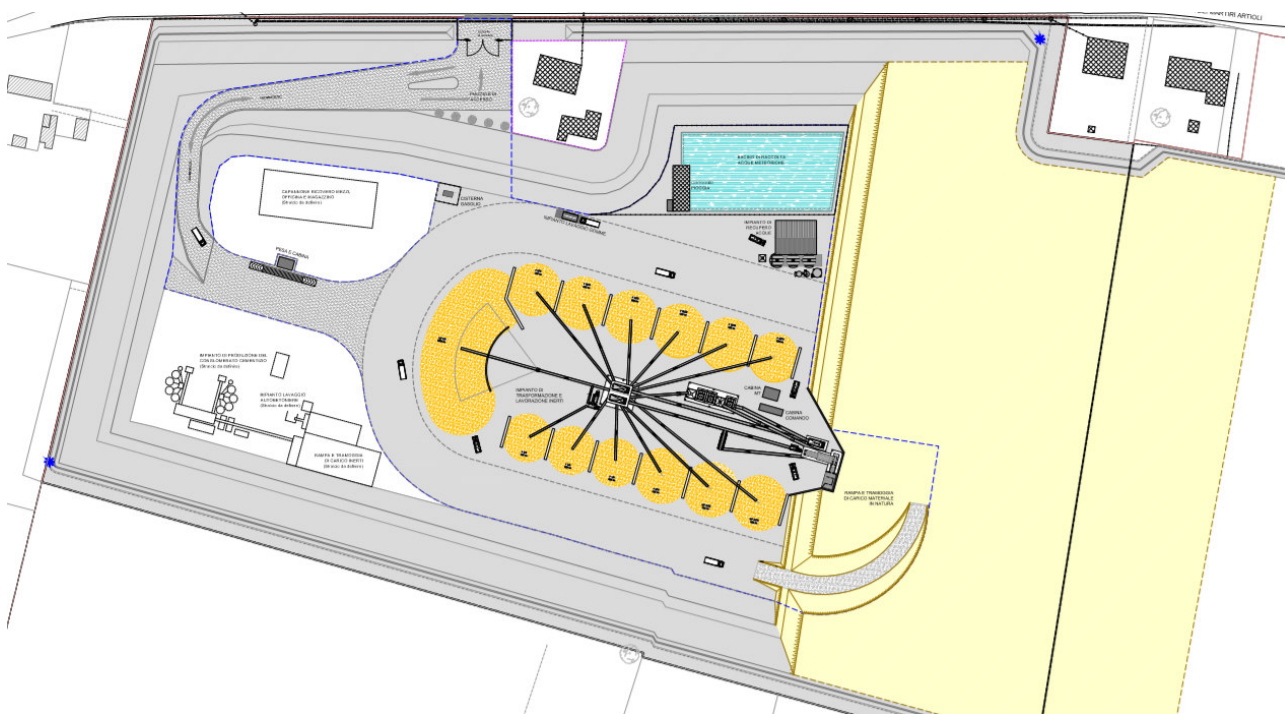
Planimetria generale del nuovo frantoio San Cesario – Ipotesi di realizzazione
